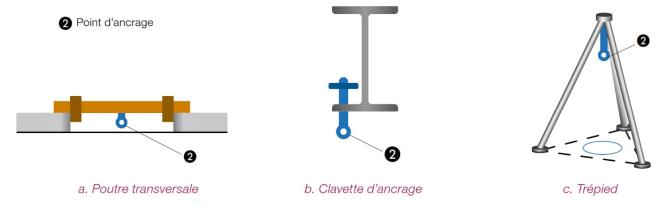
Classe B - Exemples de dispositifs d'ancrage provisoires transportables
